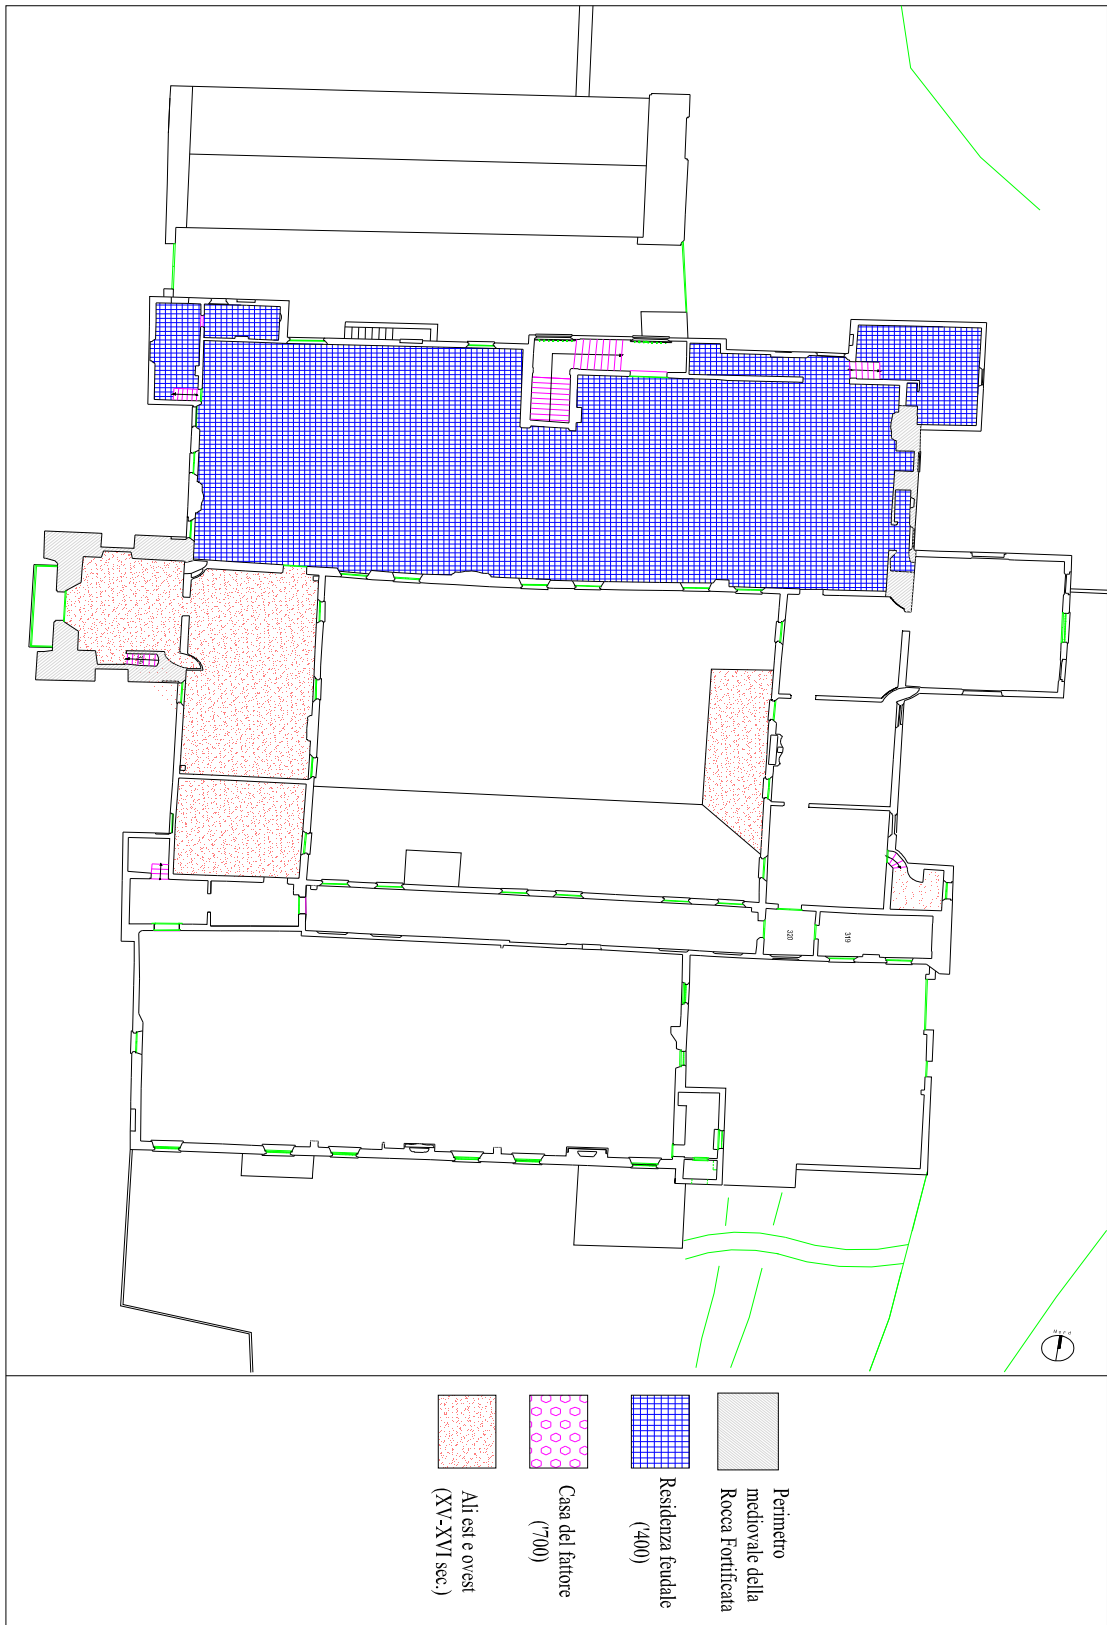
Planimetria delle fasi costruttive del piano nobile
